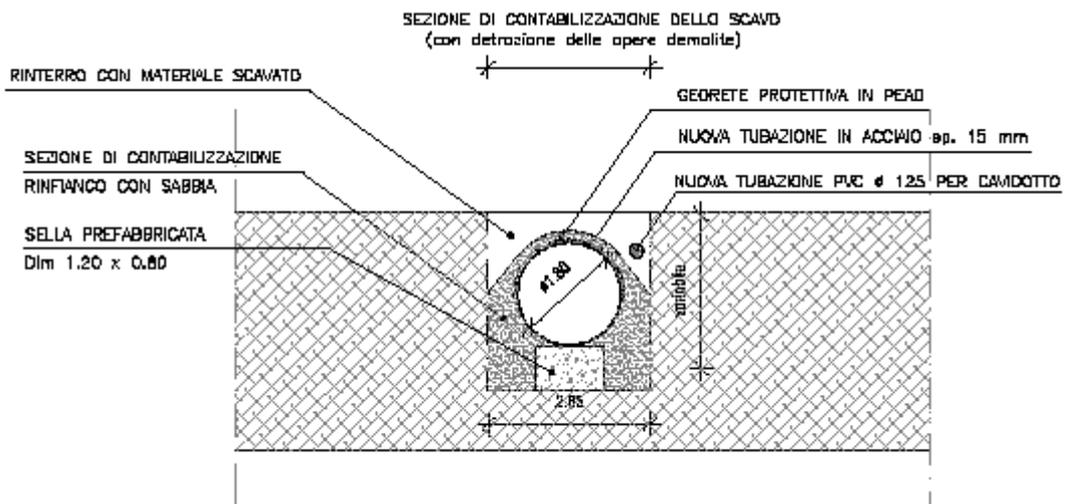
sezione tipo nei tratti interrati della nuova condotta forzata in acciaio.
